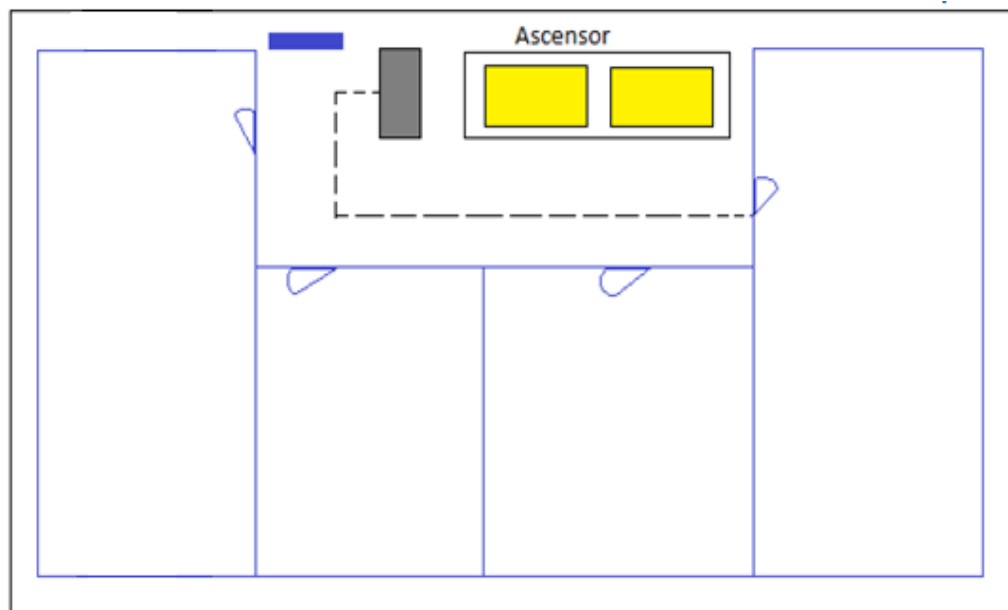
Plano Arquitectónico del sexto piso (no a escala).
